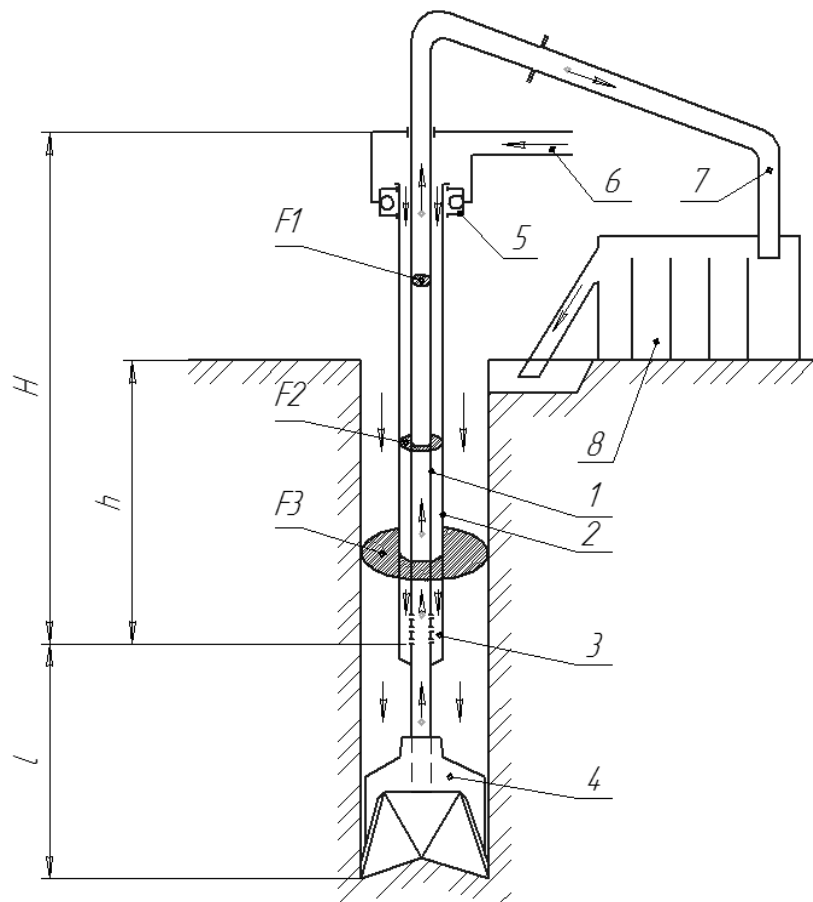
Розрахункова схема ерліфта: 1 – внутрішні труби; 2 – зовнішні труби; 3 – змішувач; 4 – породоруйнівний інструмент; 5 – сальник-вертлюг; 6 – повітряний рукав; 7 – відвідний рукав; 8 – шламозбірник
